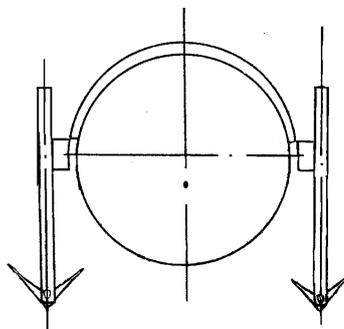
Сварные анкера раскрывающегося типа
